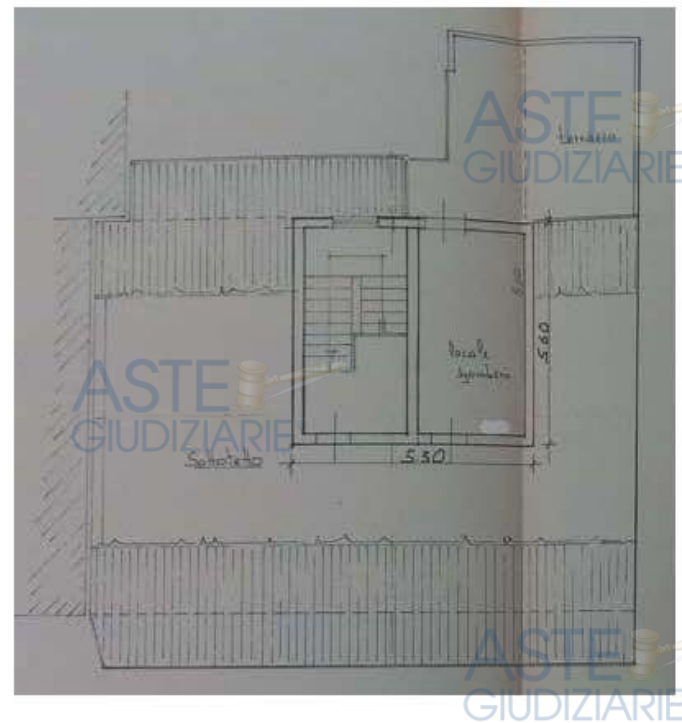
Confronto tra planimetria catastale e Concessione Edilizia di variante del locale sottotetto
